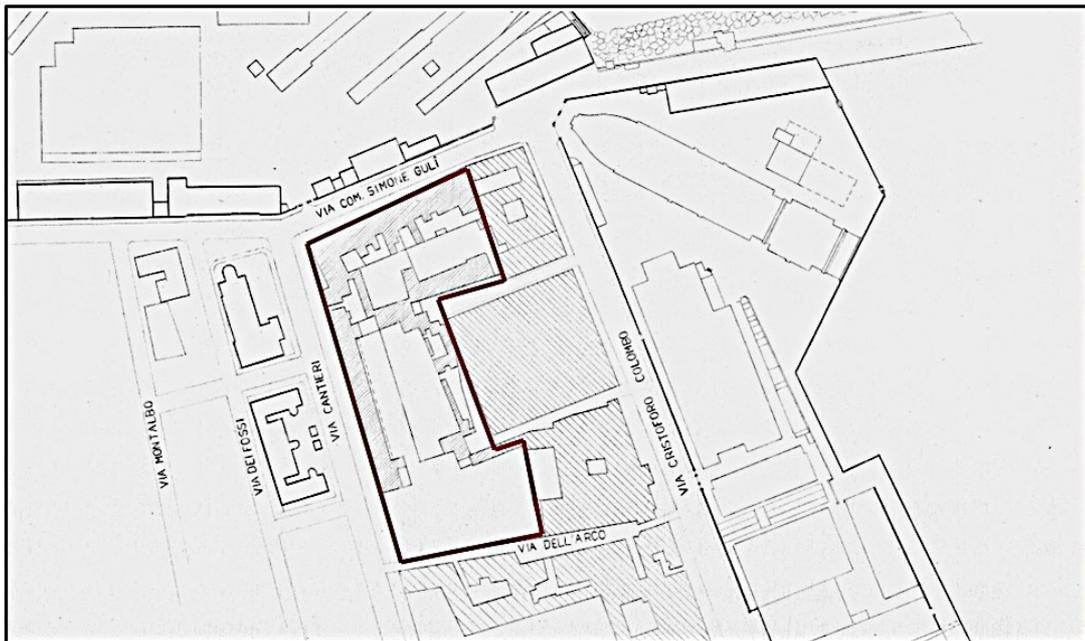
Stralcio da planimetria C.N.R. «Pianta fabbricati zona adiacente cantiere» Palermo 27.5.1940. Estratto con atto del prefetto datato 9 dicembre 1941. Fonte AFPa
